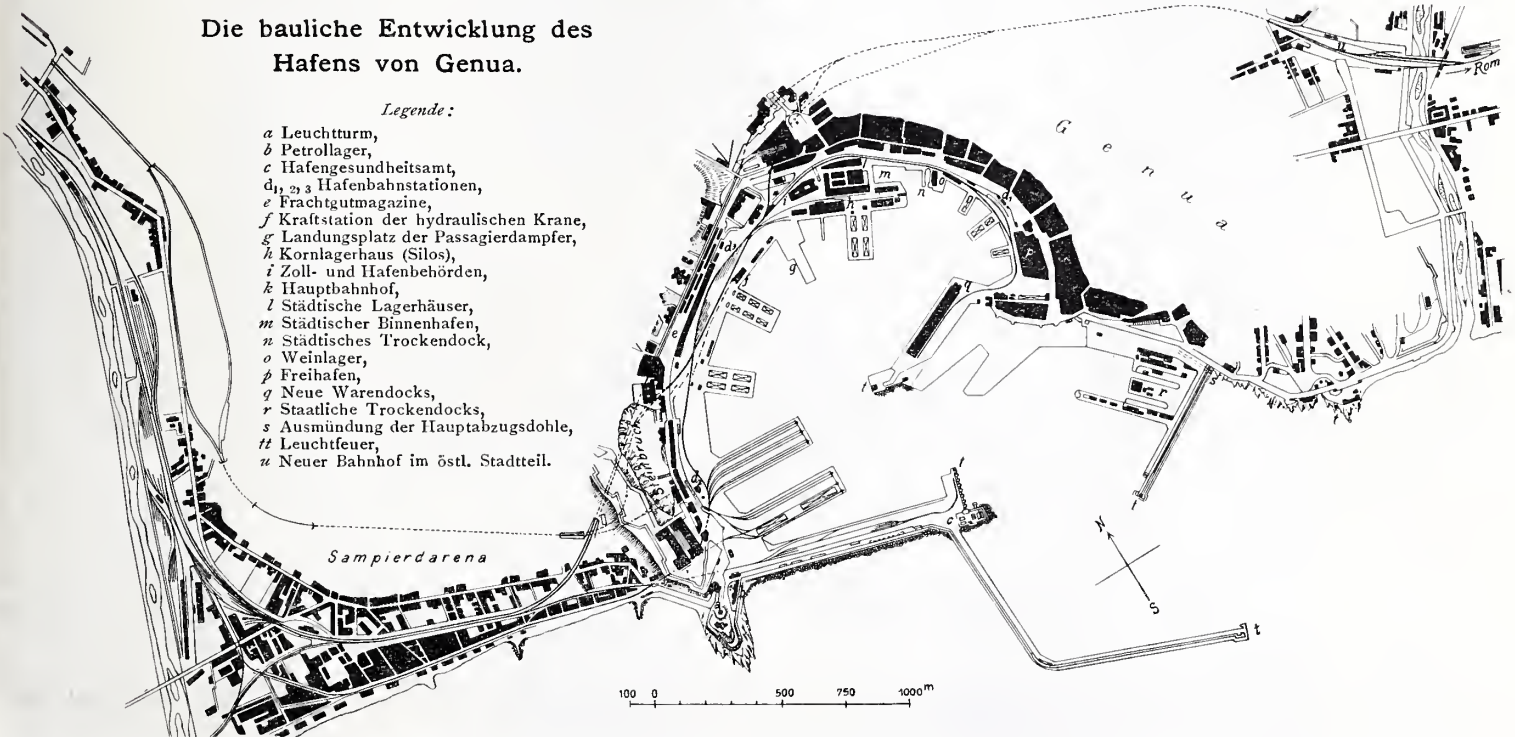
Lageplan des Hafens im Jahre 1904. — Masstab 1 : 30 000.
